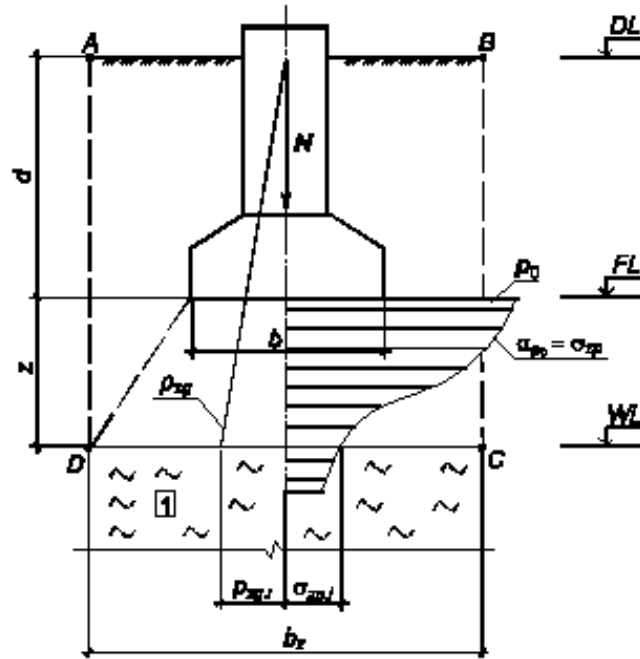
Расчетная схема для проверки прочности слабого подстилающего слоя грунта
